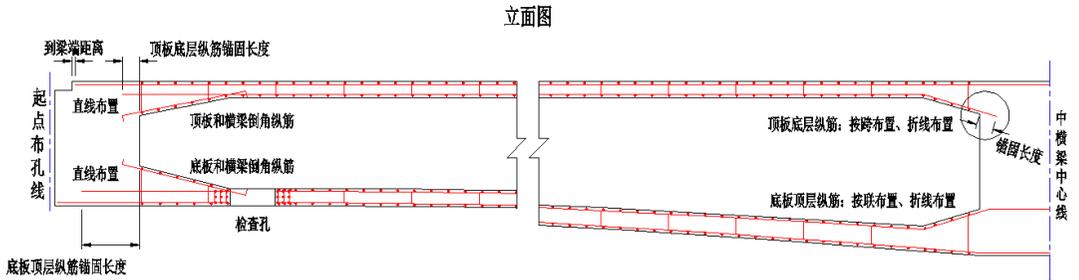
箱梁钢筋-纵筋立面示意
